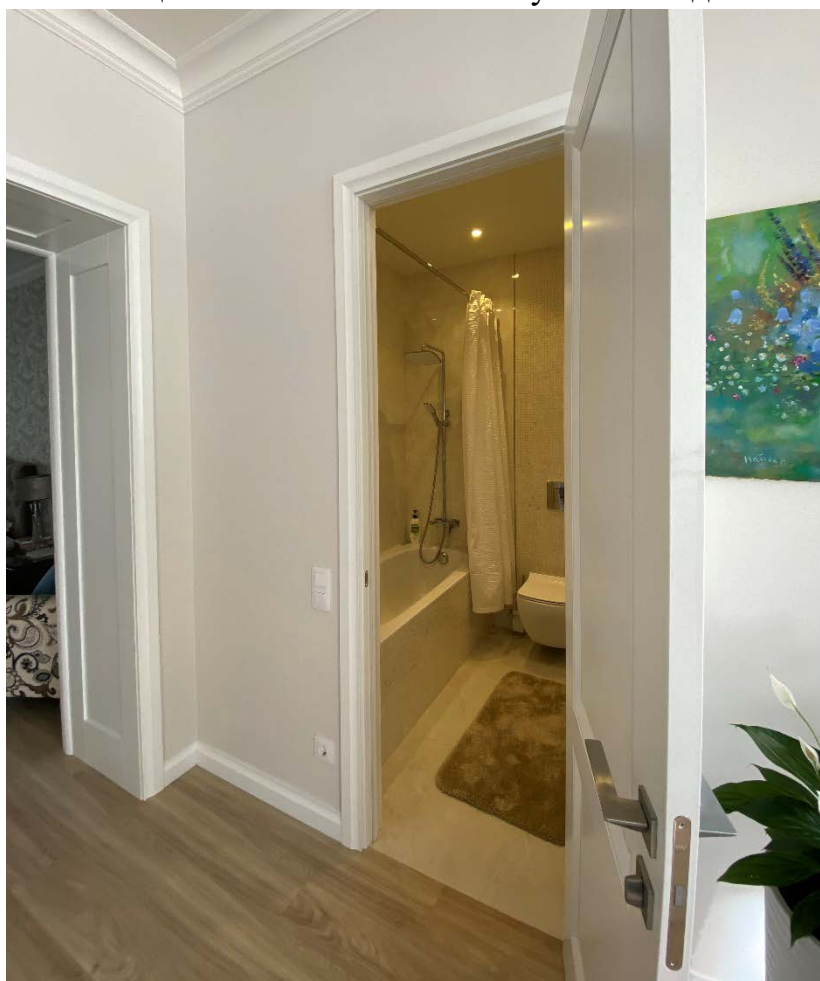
Помещение № 4 согласно плану ПИБ. Вид с северо-запада.
